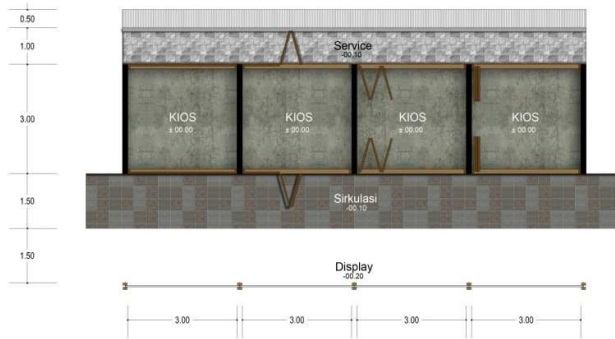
Layout Plan Pasar Burung Baru Kota Pasuruan
